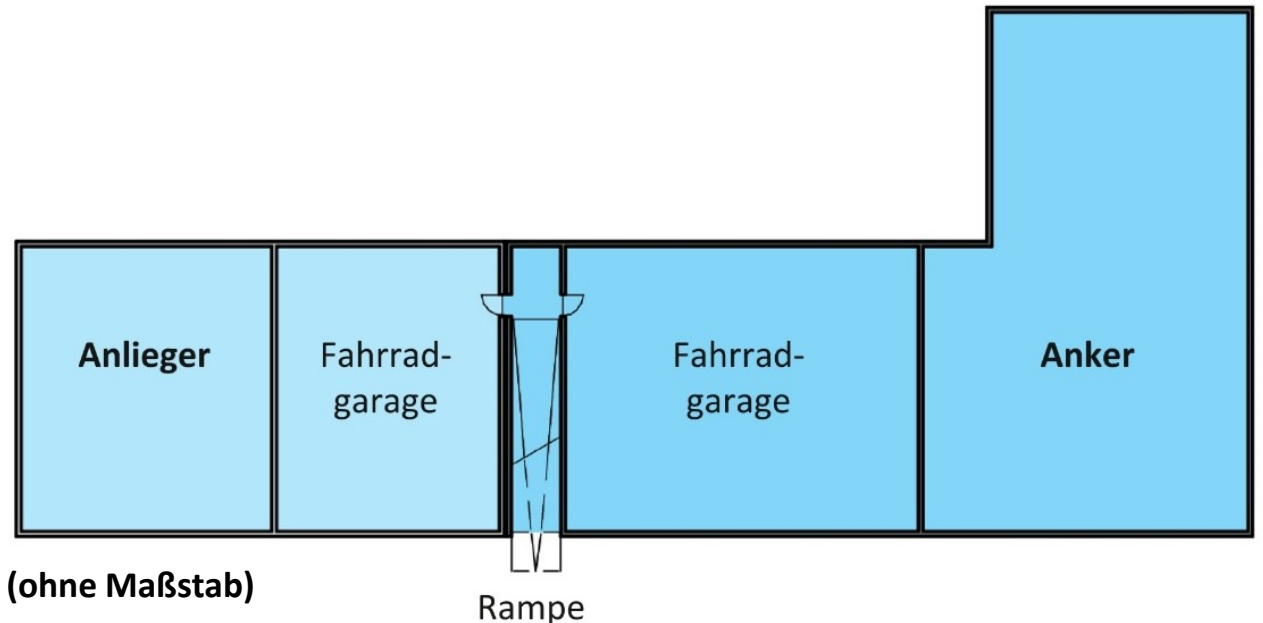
schematischer Grundriss des Untergeschosses vom MU 7 (ohne Maßstab)
